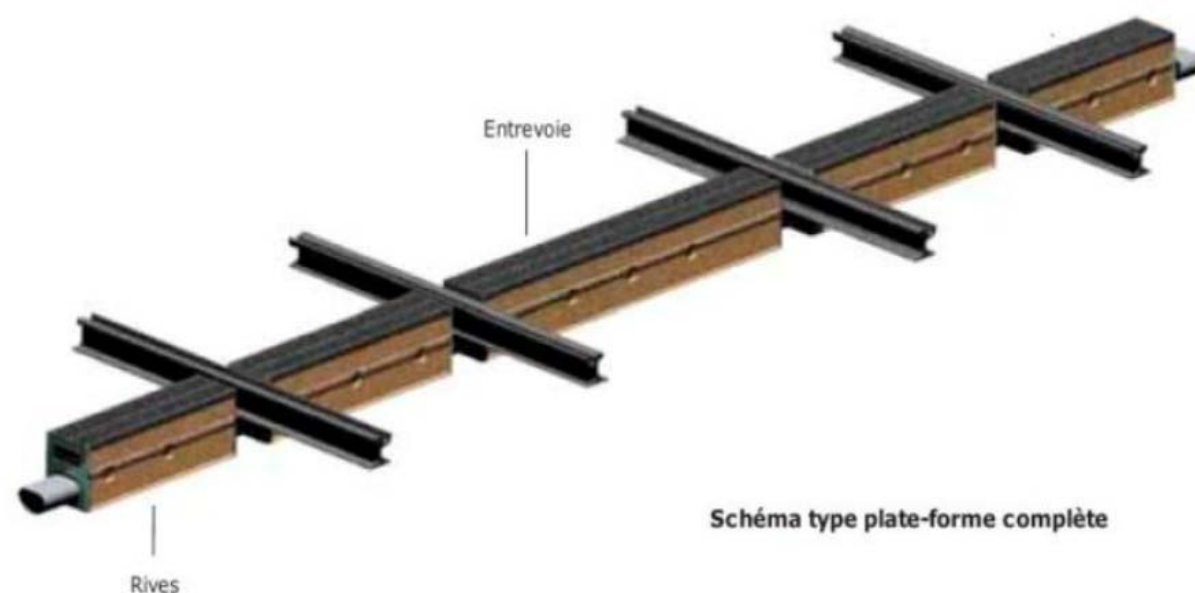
Caniveau à grille (Source : ACO, drainage de plateforme)
